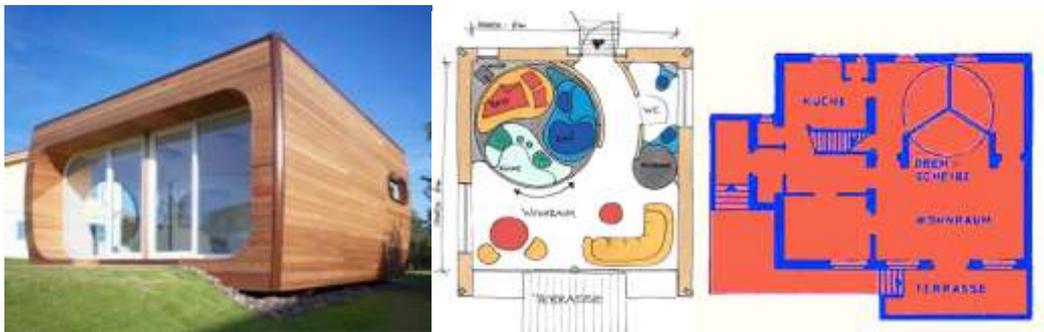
Rotor Housa: a) Vista exterior; b) Planta (Disponível em: www.design-magazine.it); c) *Four single-detached House* de E. Mendelsohn (SCHNEIDER & TILL, 2007).
